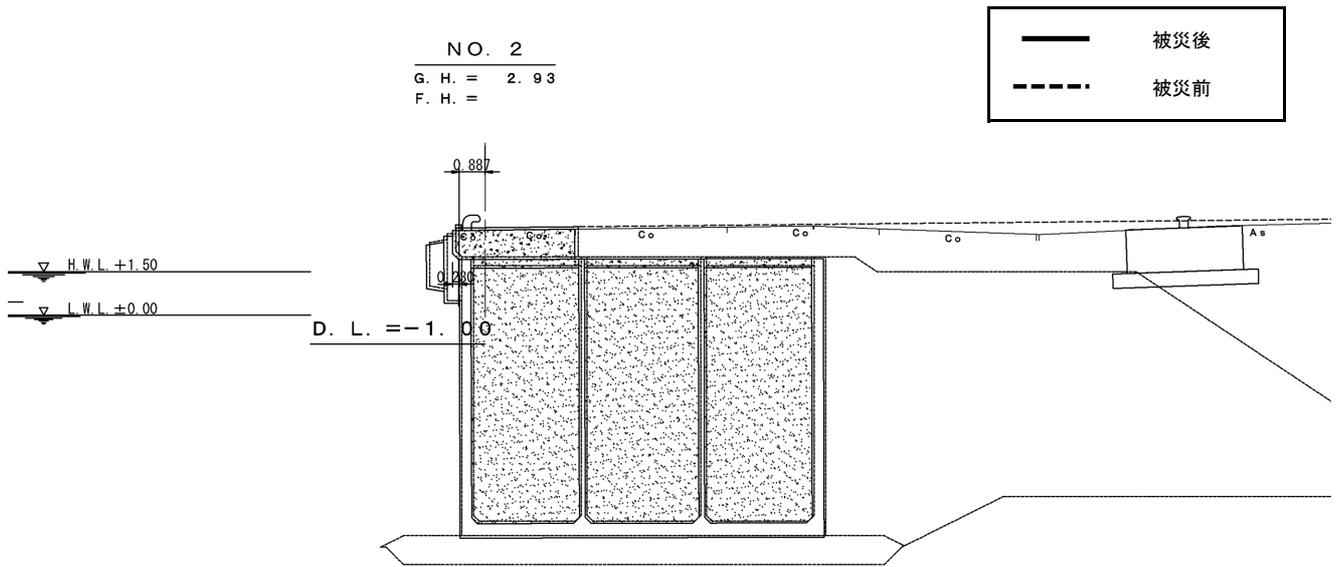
236 No.20 常陸那珂港区_中央ふ頭地区岸壁 (-7.5m) の断面図 (被災後)
